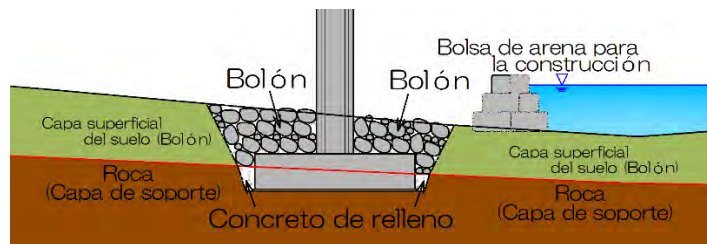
Obra de prevención de socavamiento de la pila del Puente Prinzapolka
